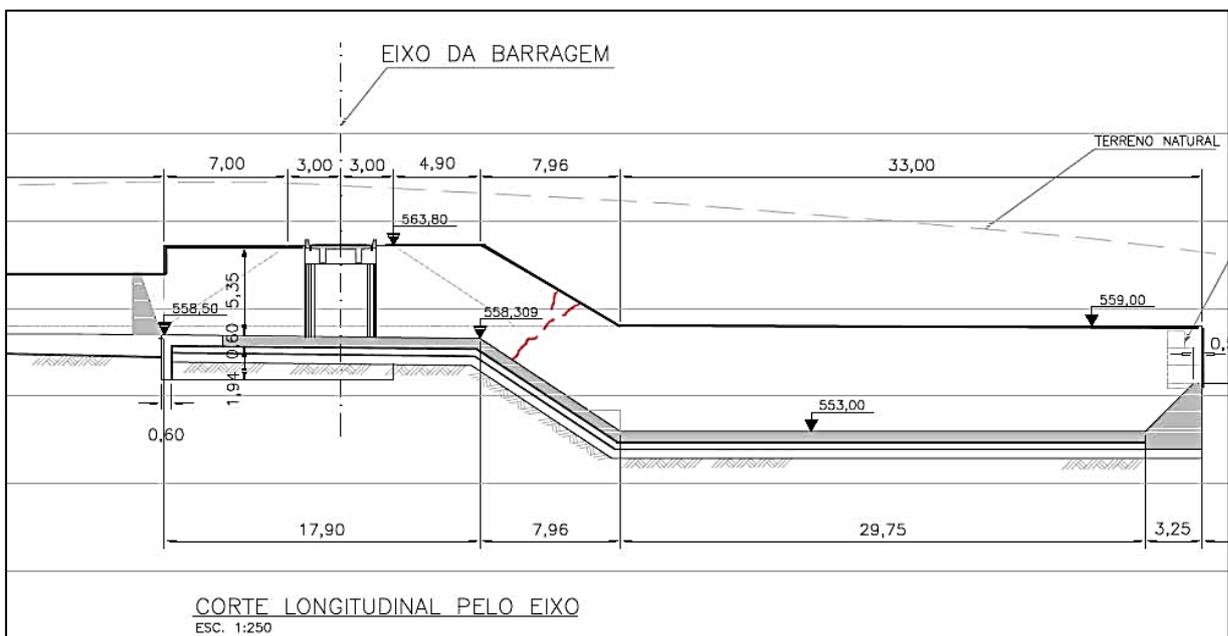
corte longitudinal do Vertedouro e da Bacia de dissipação, com a localização da anomalia (fissuras) marcadas em vermelho
